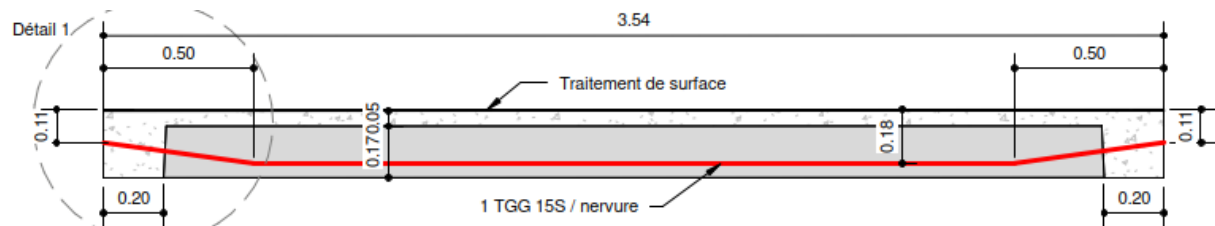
Coupe longitudinale d'un platelage de type 4 et tracé des câbles - Extrait du cahier de plans PRO
